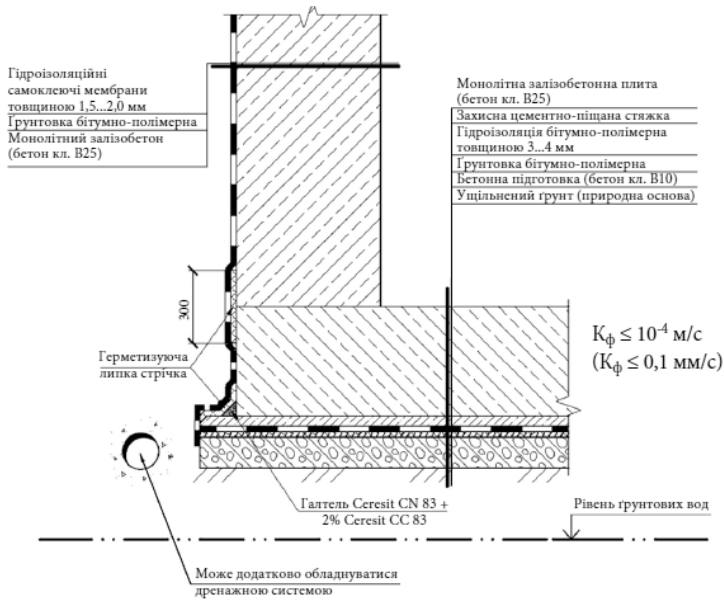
Гідроізоляція бетонних плит основи і стін підземних споруд в умовах впливу нескупченої фільтраційної води.
